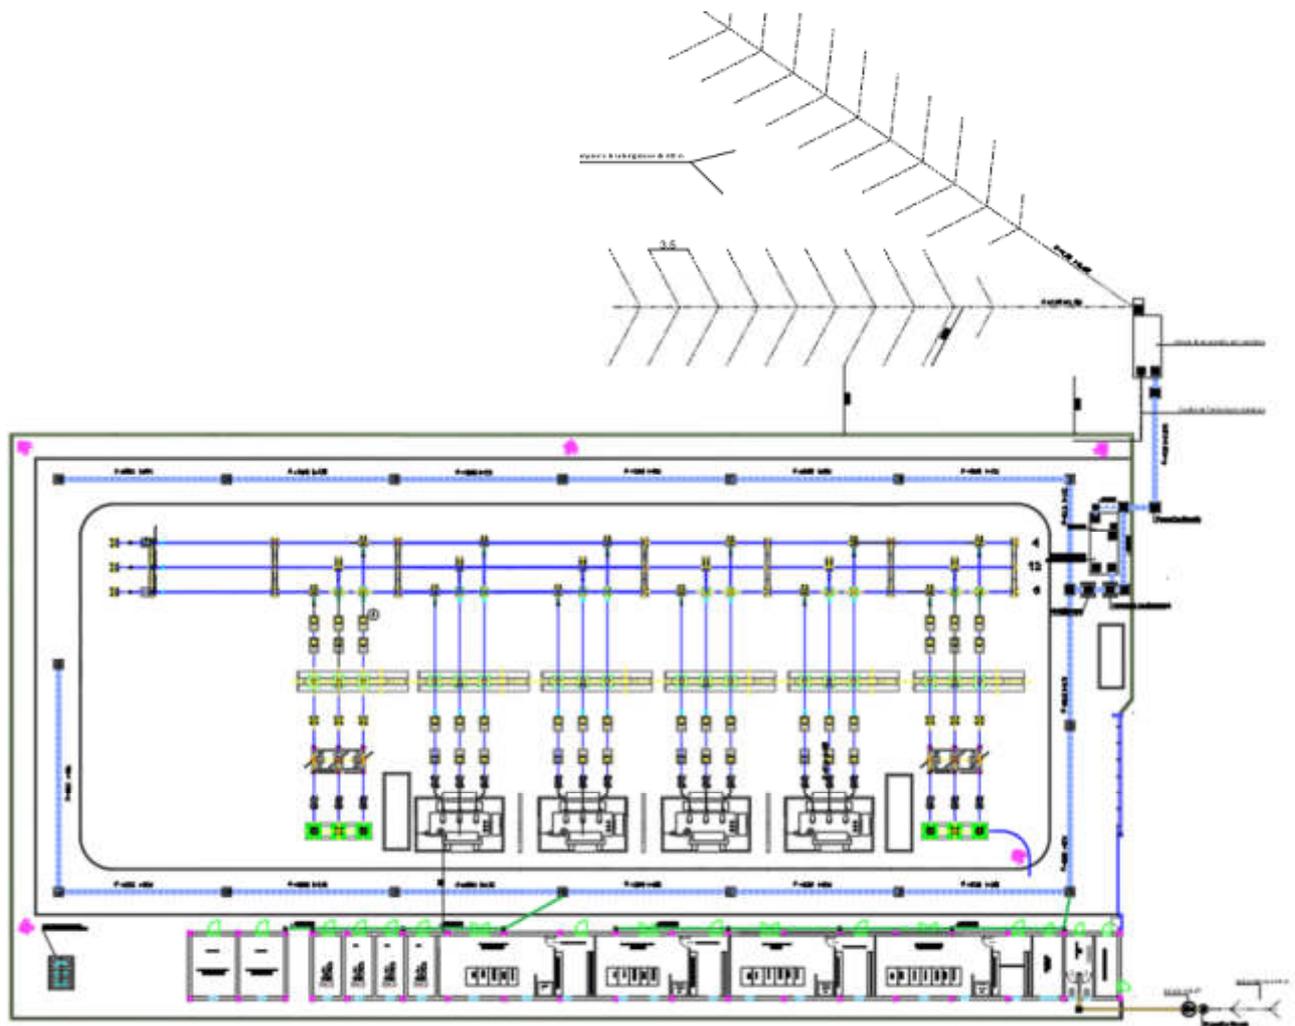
Planimetria della rete di drenaggio interna con indicazione del recapito finale delle acque meteoriche
